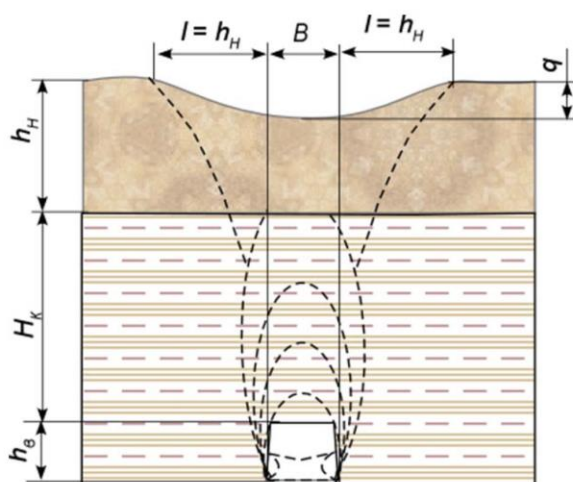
Схема формирования свода обрушения над горизонтальной подготовительной выработкой, находящейся на малой глубине
